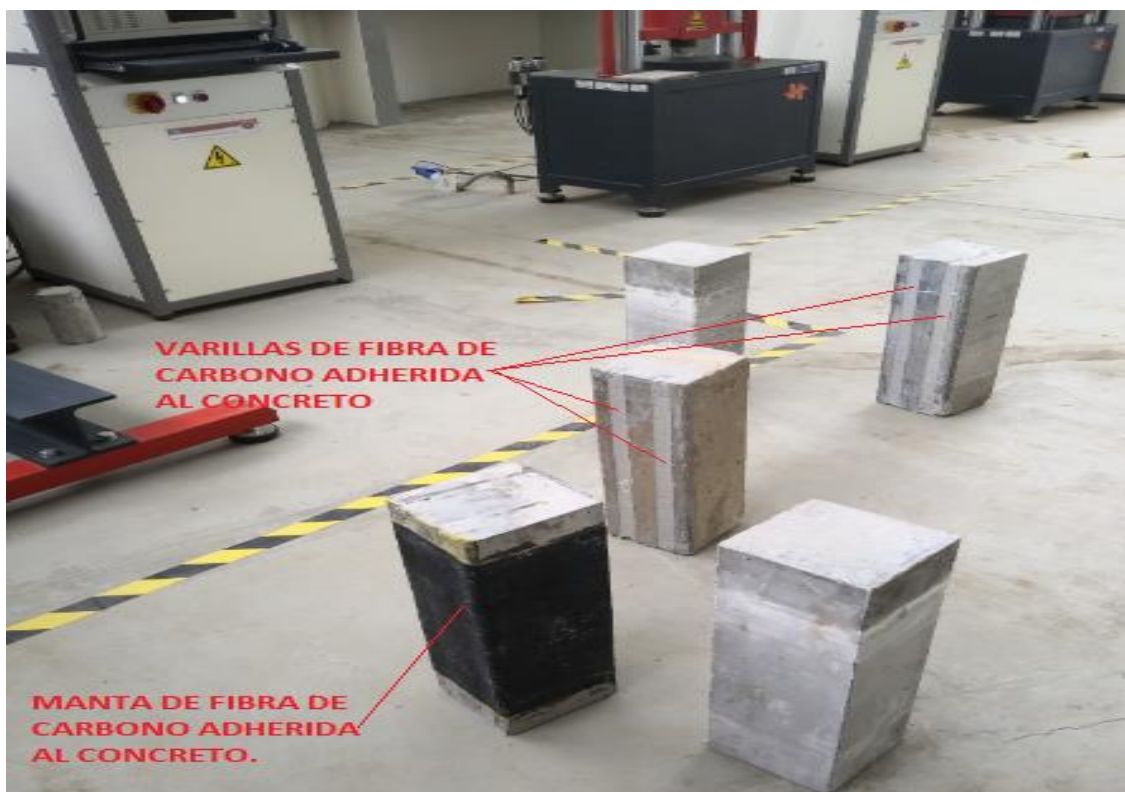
Varillas Adheridas al Concreto para el Ensayo. Fuente propia.
